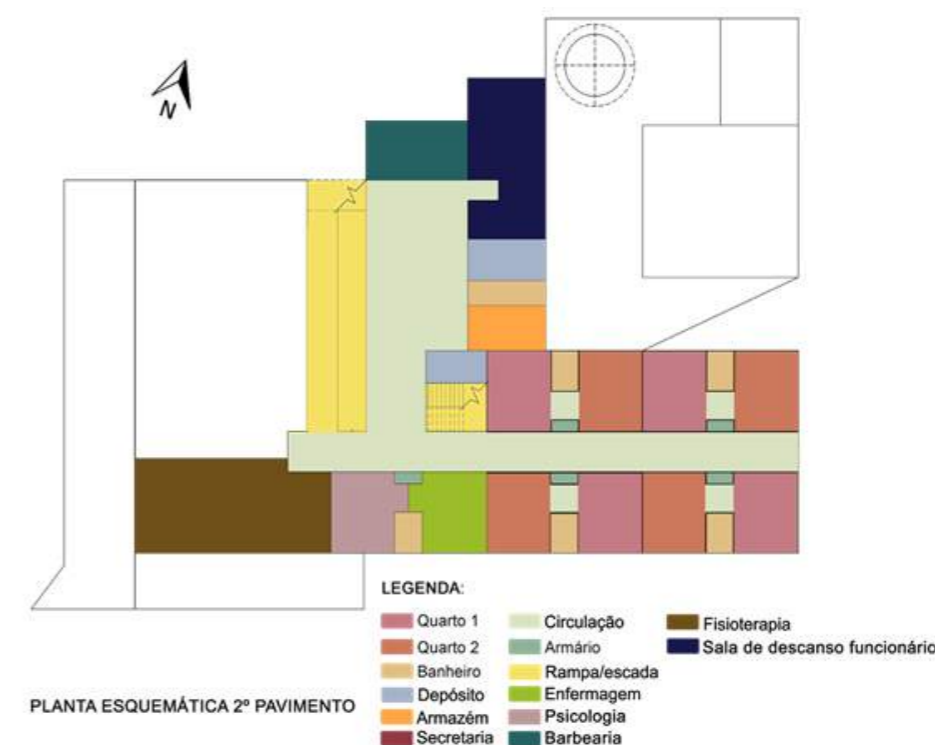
Planta esquemática do 2º pavimento da Instituição “A”.
